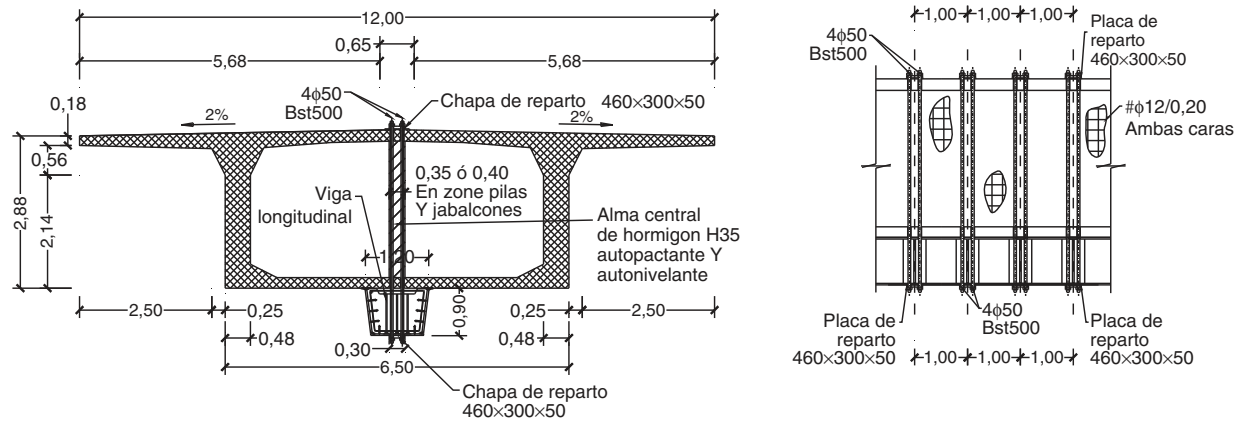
Alzado y sección transversal del alma central y el cajón metálico longitudinal.
